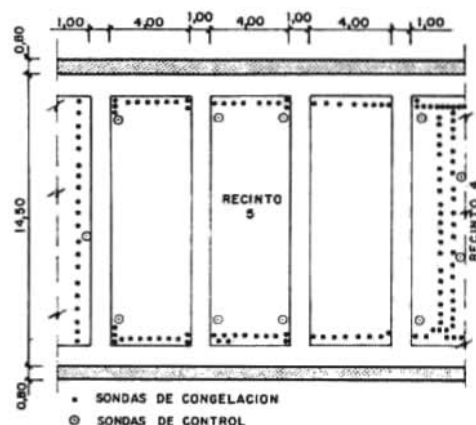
Planta con situación de sondas en el Recinto 5 de la Estación
